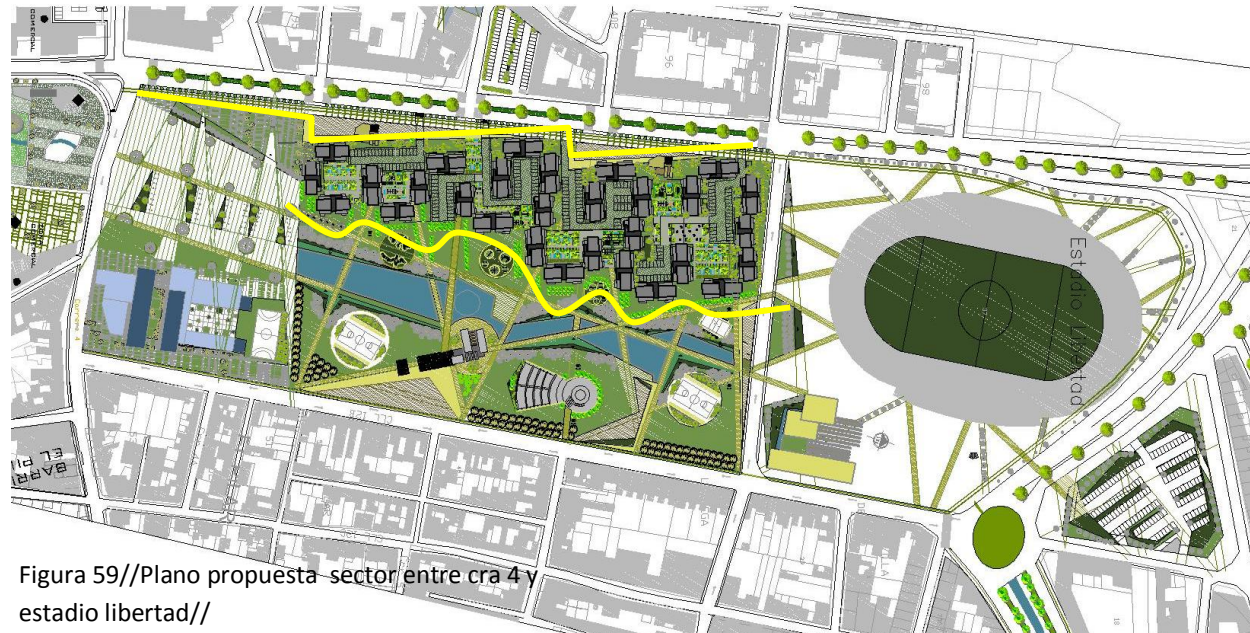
//Plano propuesta sector entre cra 4 y estadio libertad//
